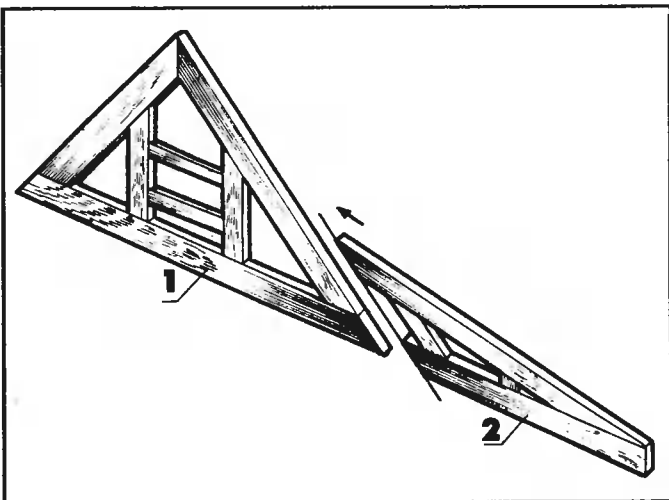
Стропильные фермы: 1 – для комнаты; 2 – для веранды
